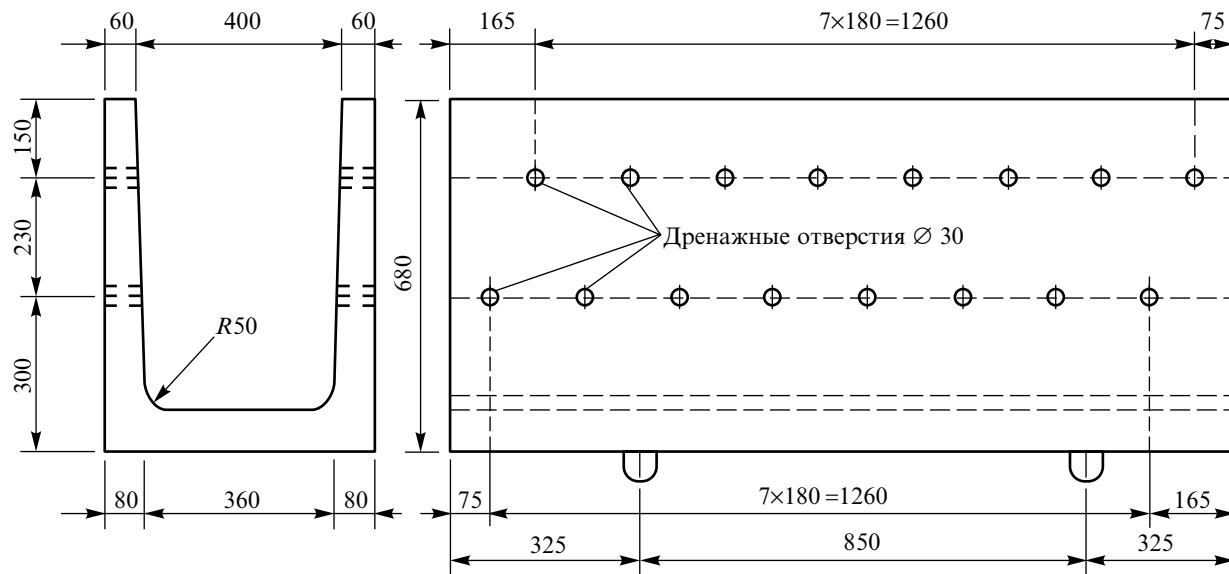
Железобетонные лотки безраспорные (размеры в мм)
